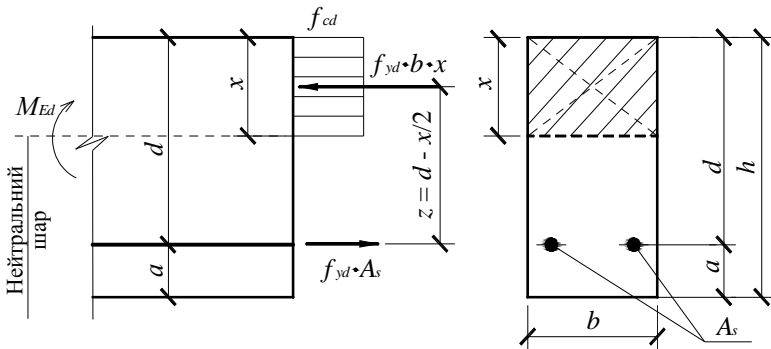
Розрахункова схема нормального перерізу прямокутного профілю з одиничною арматурою
